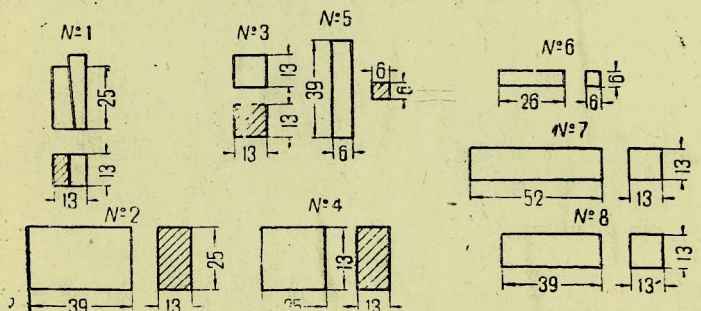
б. Чертежи деревянных форм и вкладышей для времянки сборной конструкции.
